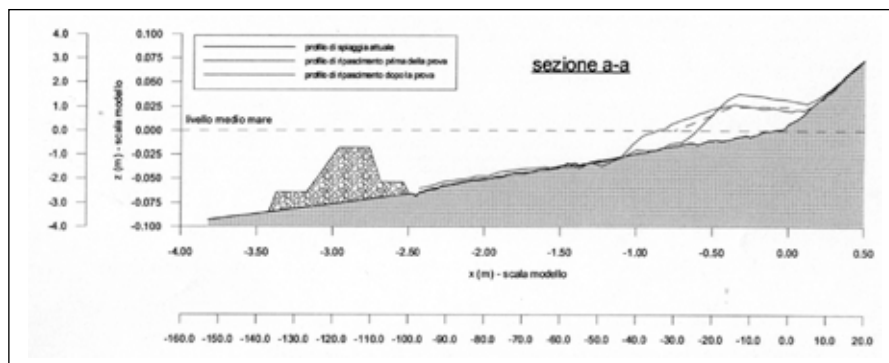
Profilo trasversale rilevato. Test B - Sezione a-a.
